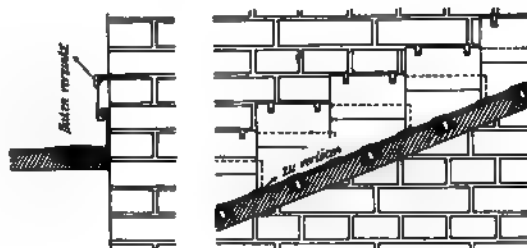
Anschluß der Dachplatte an einen gemauerten Giebel.
